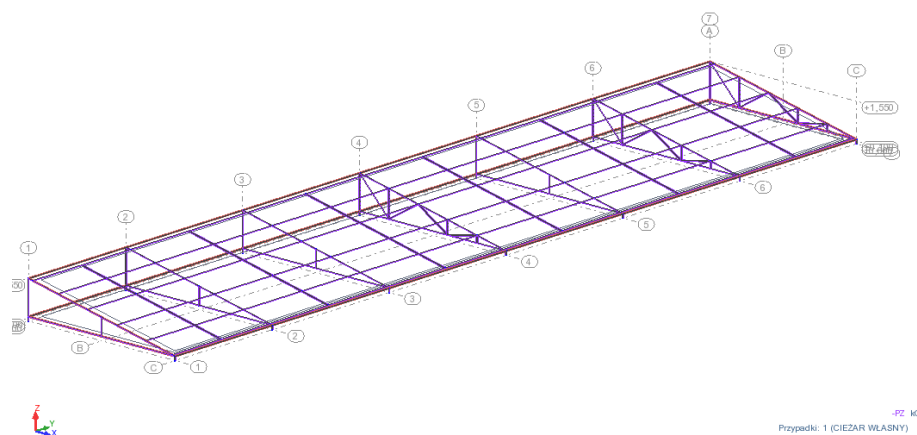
Część I - Widok konstrukcji dachu – widok z boku
